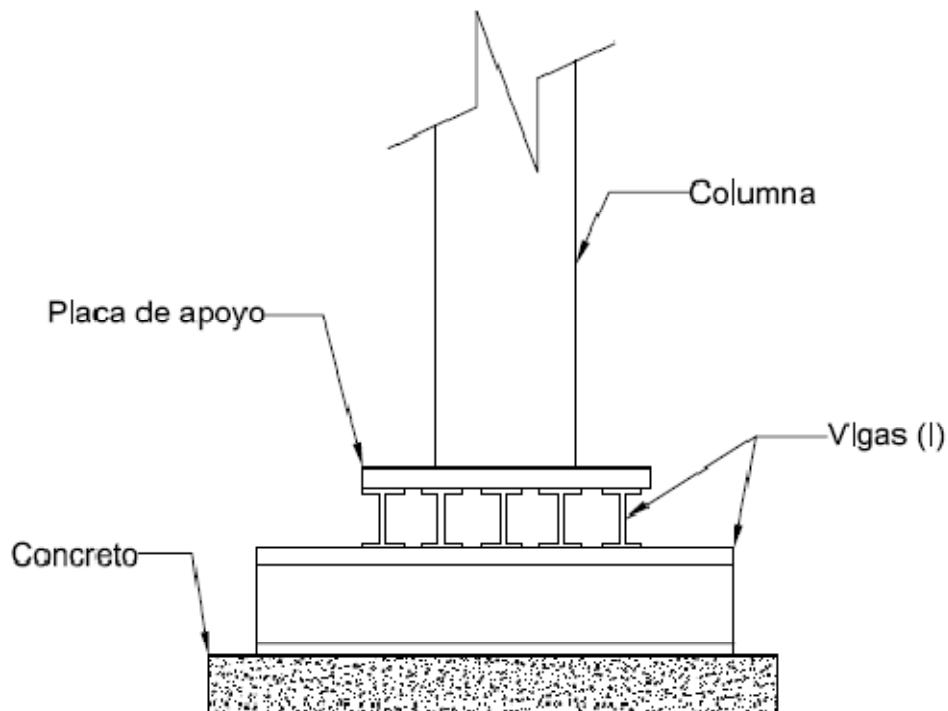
Emparrillado para cimentación con vigas (I) de acero (Galaviz 1987).
